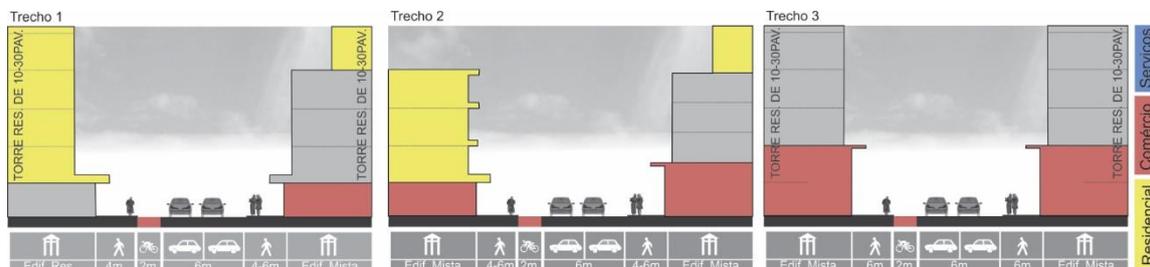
Corte esquemático dos três trechos da Avenida Brasil (fonte: autores).
